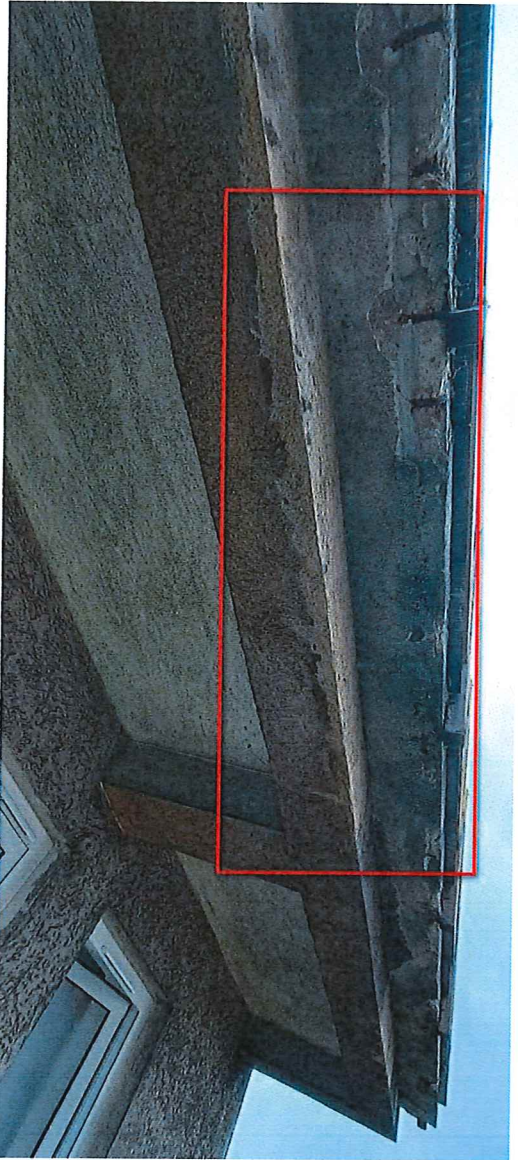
Widok przykładowego balkonu przeznaczonego do remontu.
